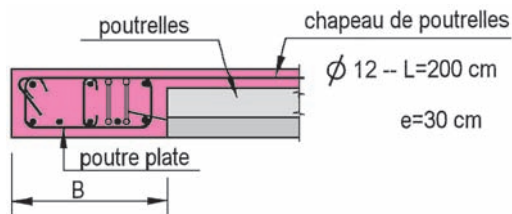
Poutre plate en rive de plancher ou en rive de trémie
